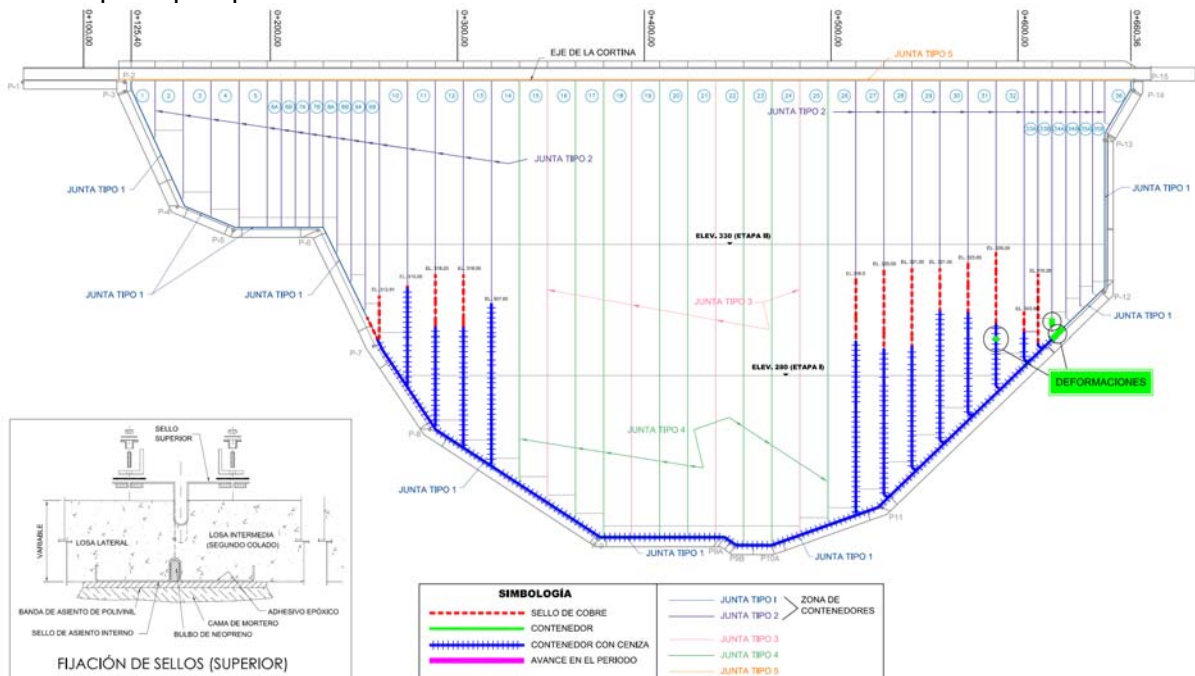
Tipos de junta en las losas de la cara de concreto.
